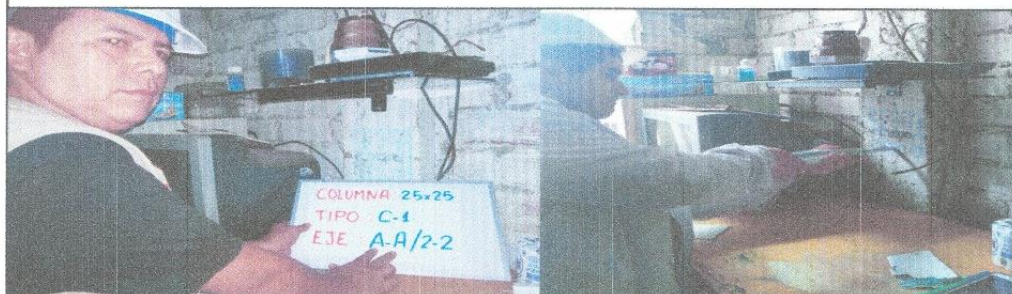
Columna ubicado en el 2do piso Eje A-A/2-2
